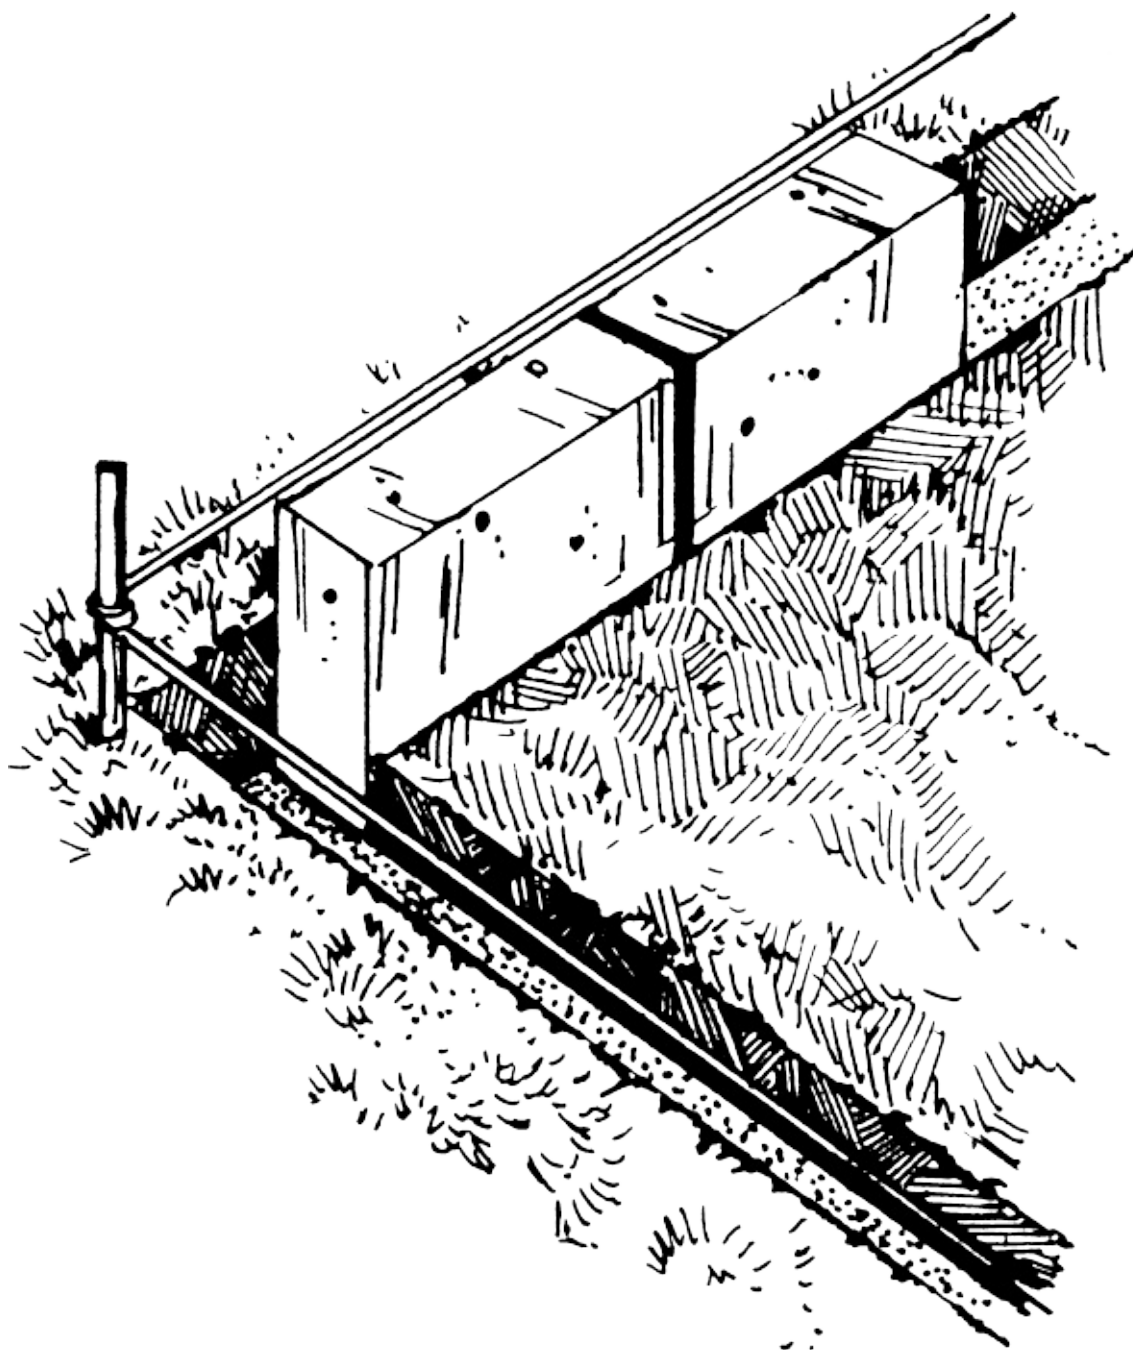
Тип укладки на бетонной стяжке и песчаной подушке
